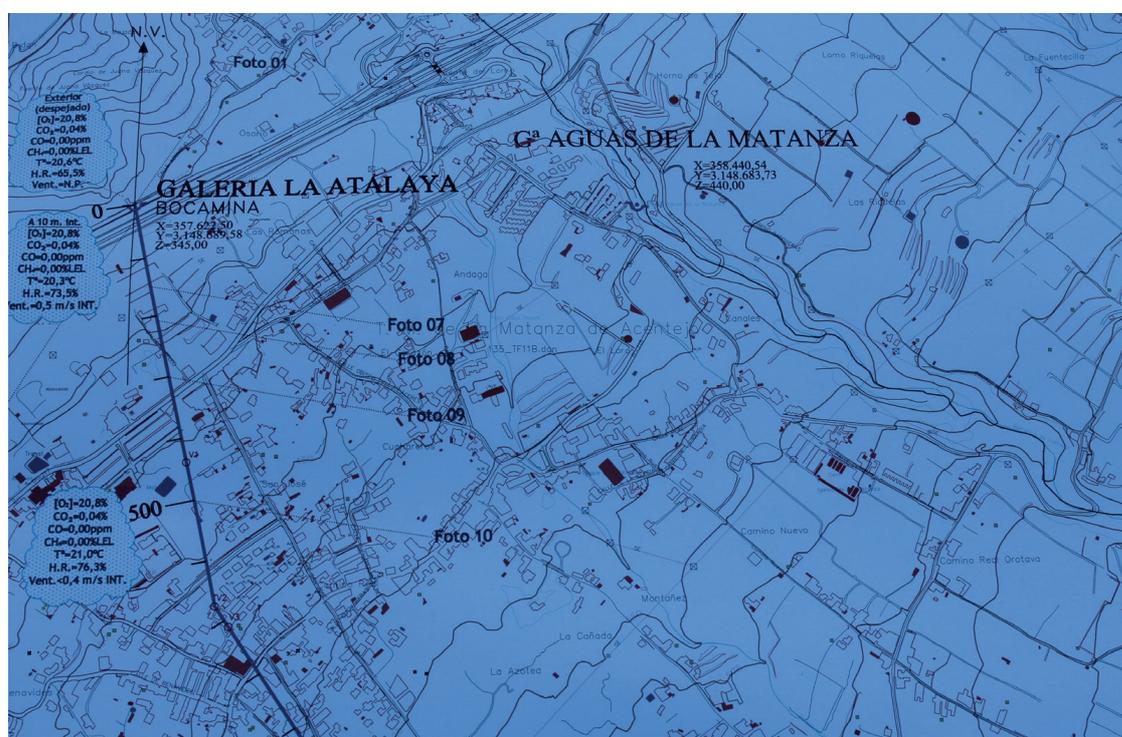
Trazado en planta y rumbos de una galería en Tenerife.
